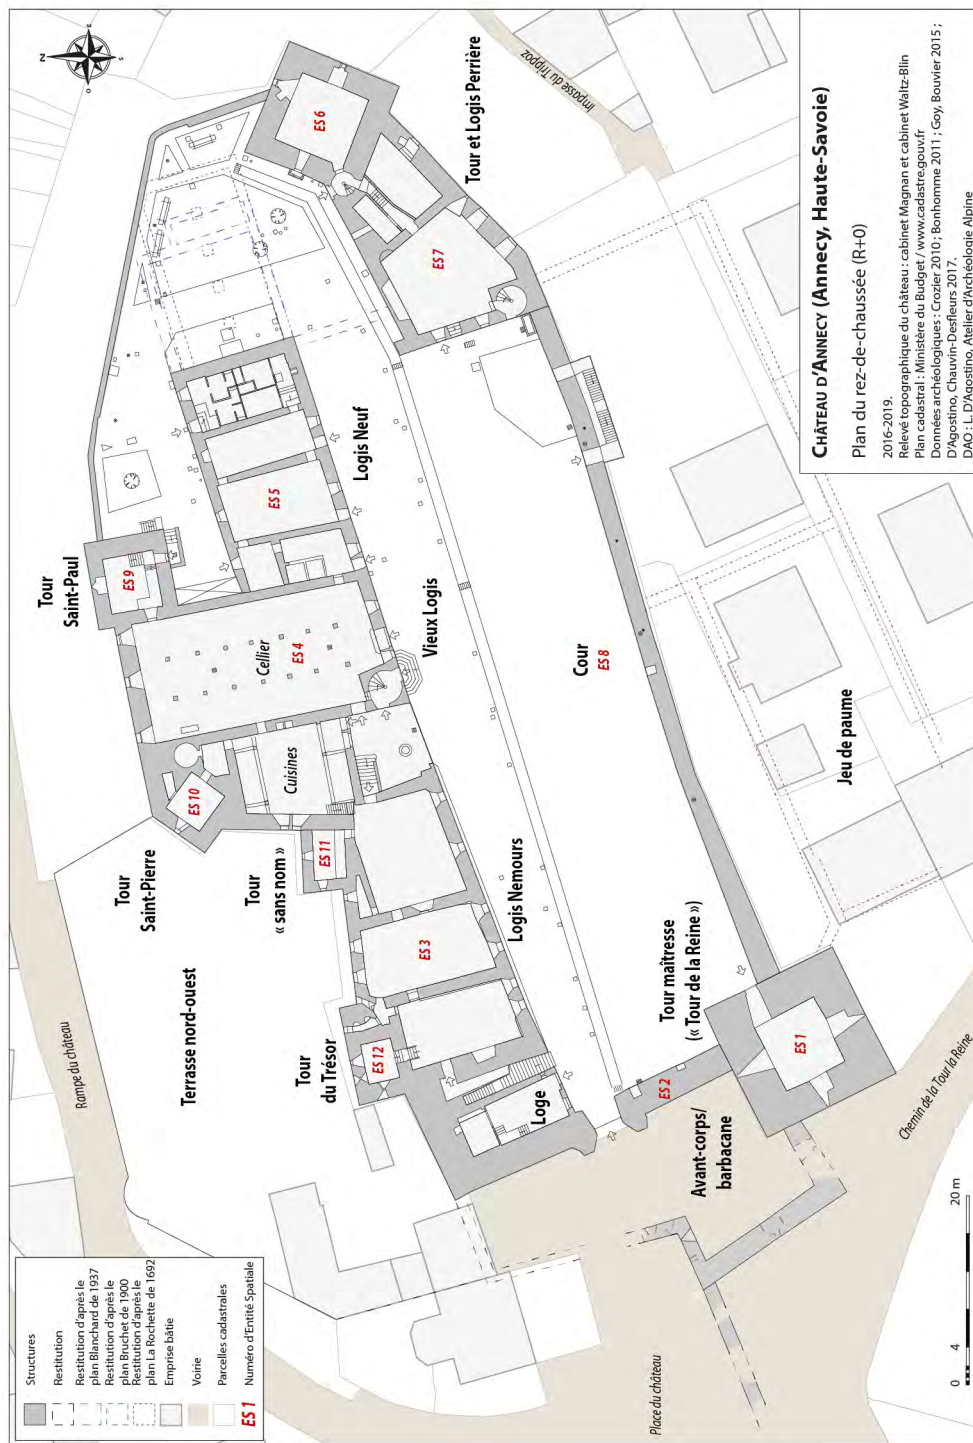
Château d'Anney. Plan général au rez-de-chaussée. Doc. : L. D'Agostino.
